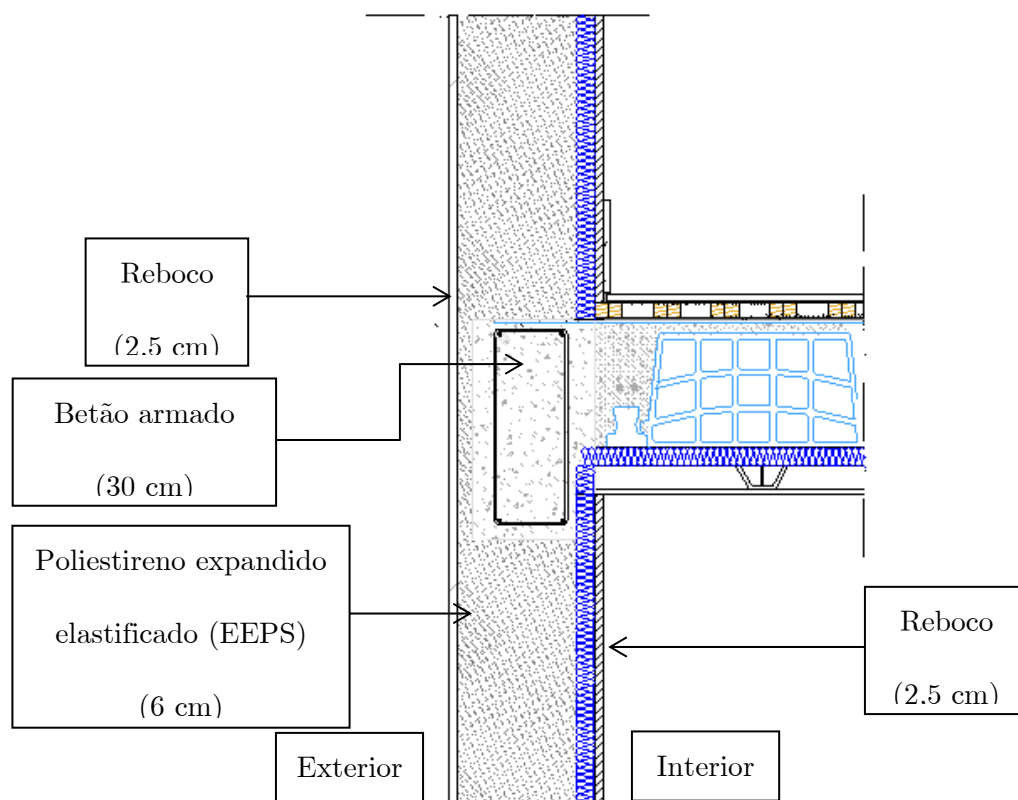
Pormenor construtivo das vigas (N<sub>3</sub>)
